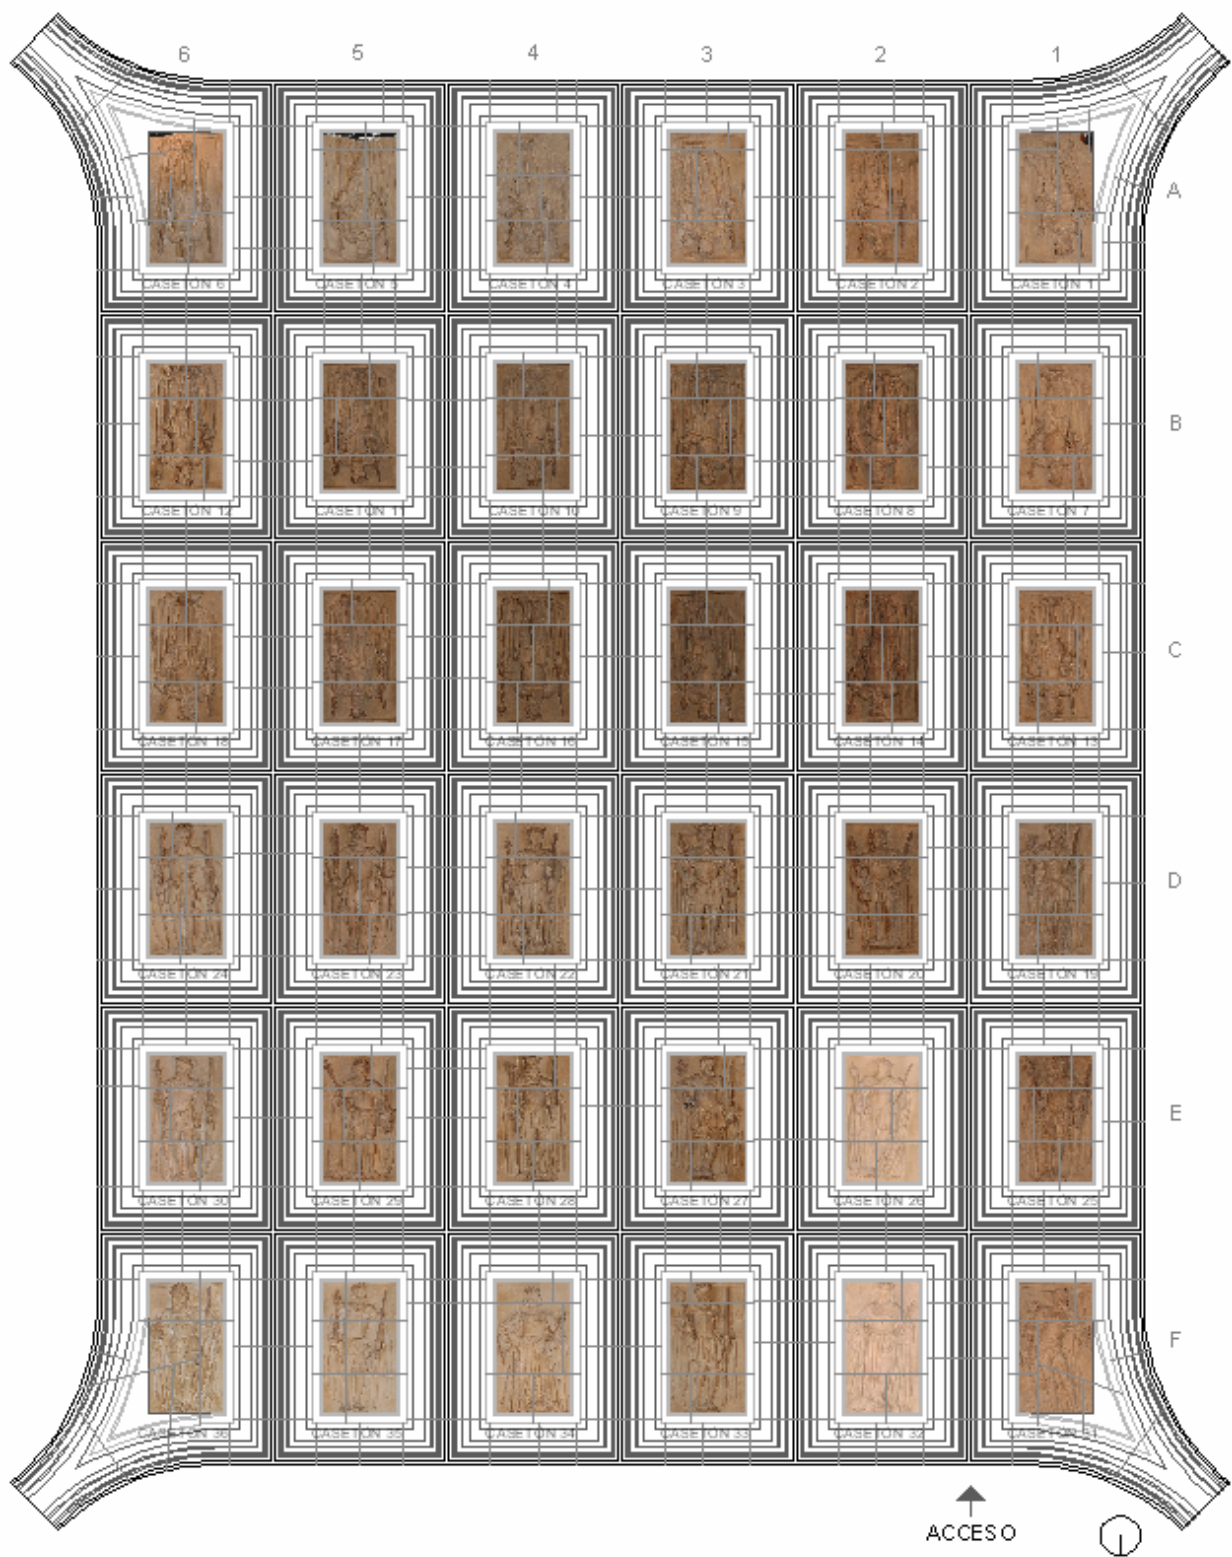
Planta abatida de la bóveda de la Sala Capitulare
